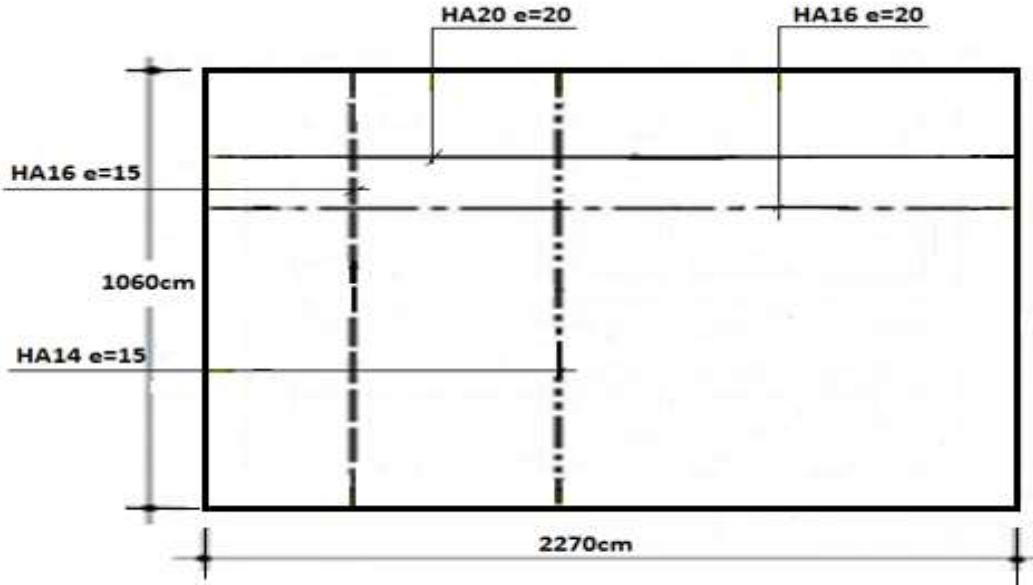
vue en plan du ferrailage radier (nappe sup et nappe inf)
